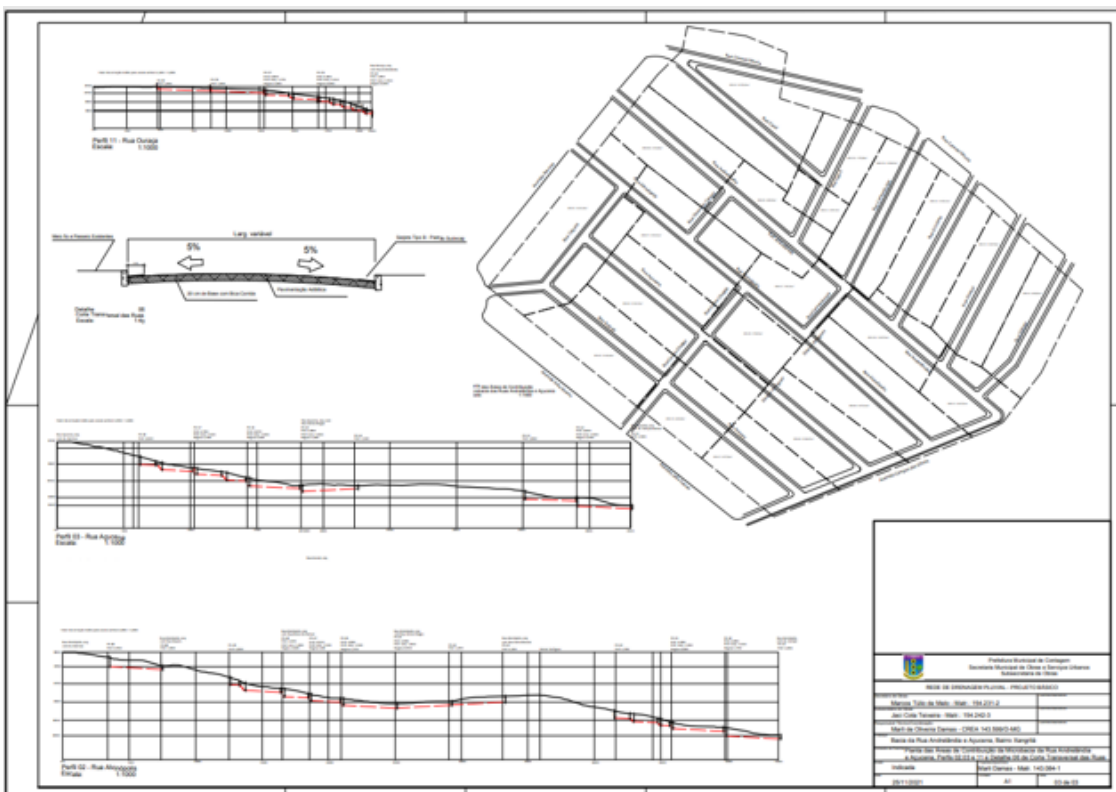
Projeto das áreas dos trechos, representação do greide e perfis longitudinais
